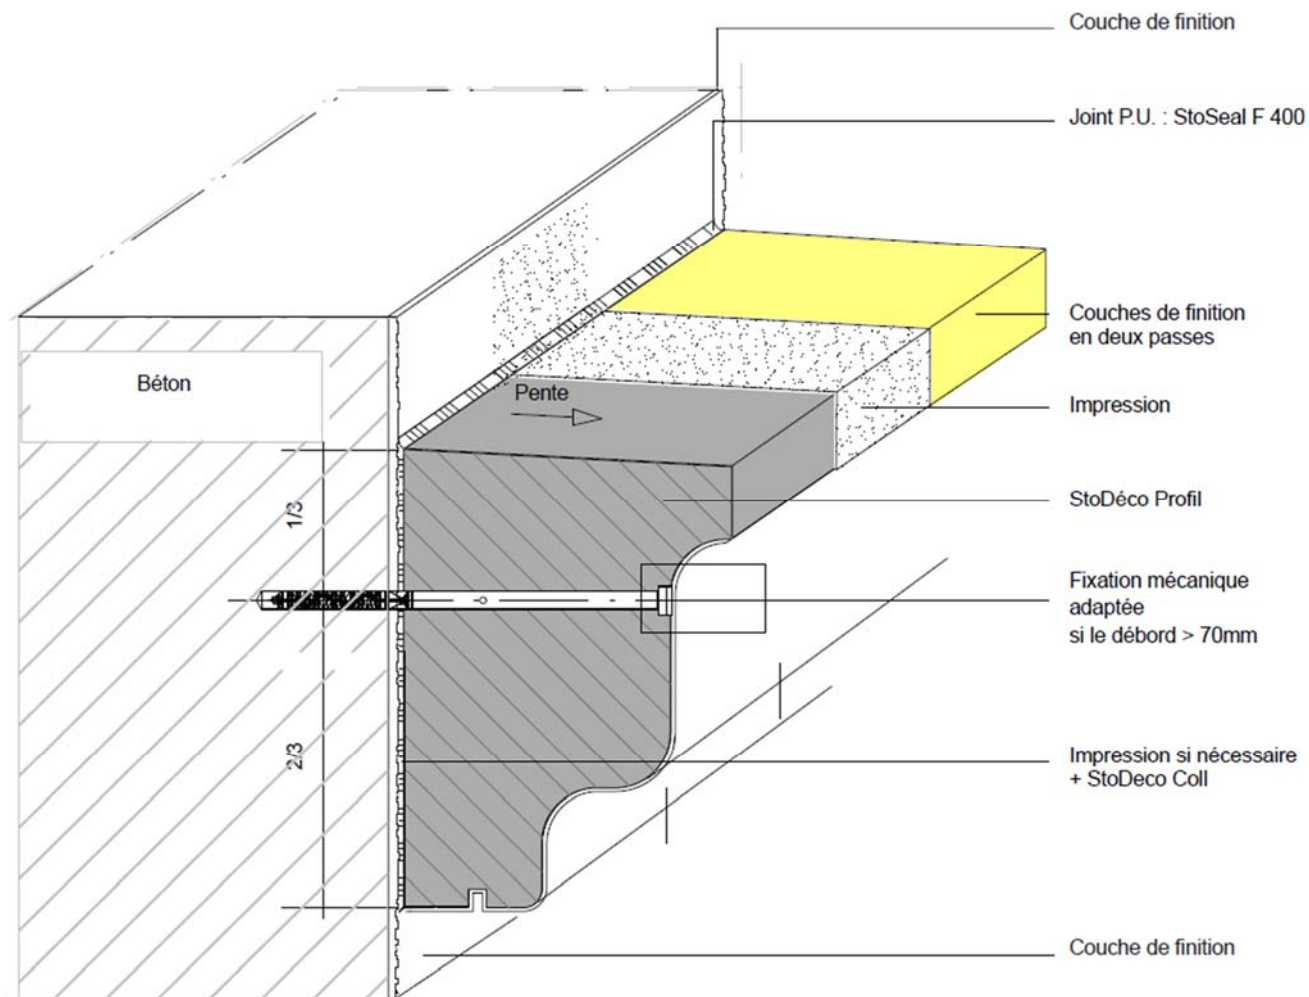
Pose d'un profilé StoDeco Profil sur béton revêtu
